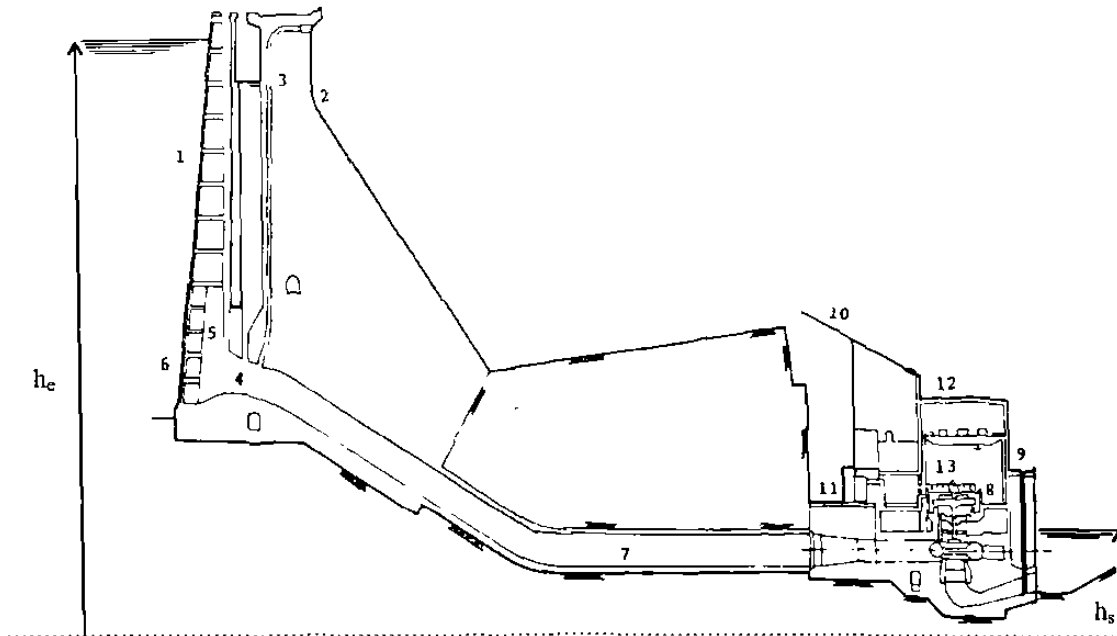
Planta hidroeléctrica de almacenamiento.
